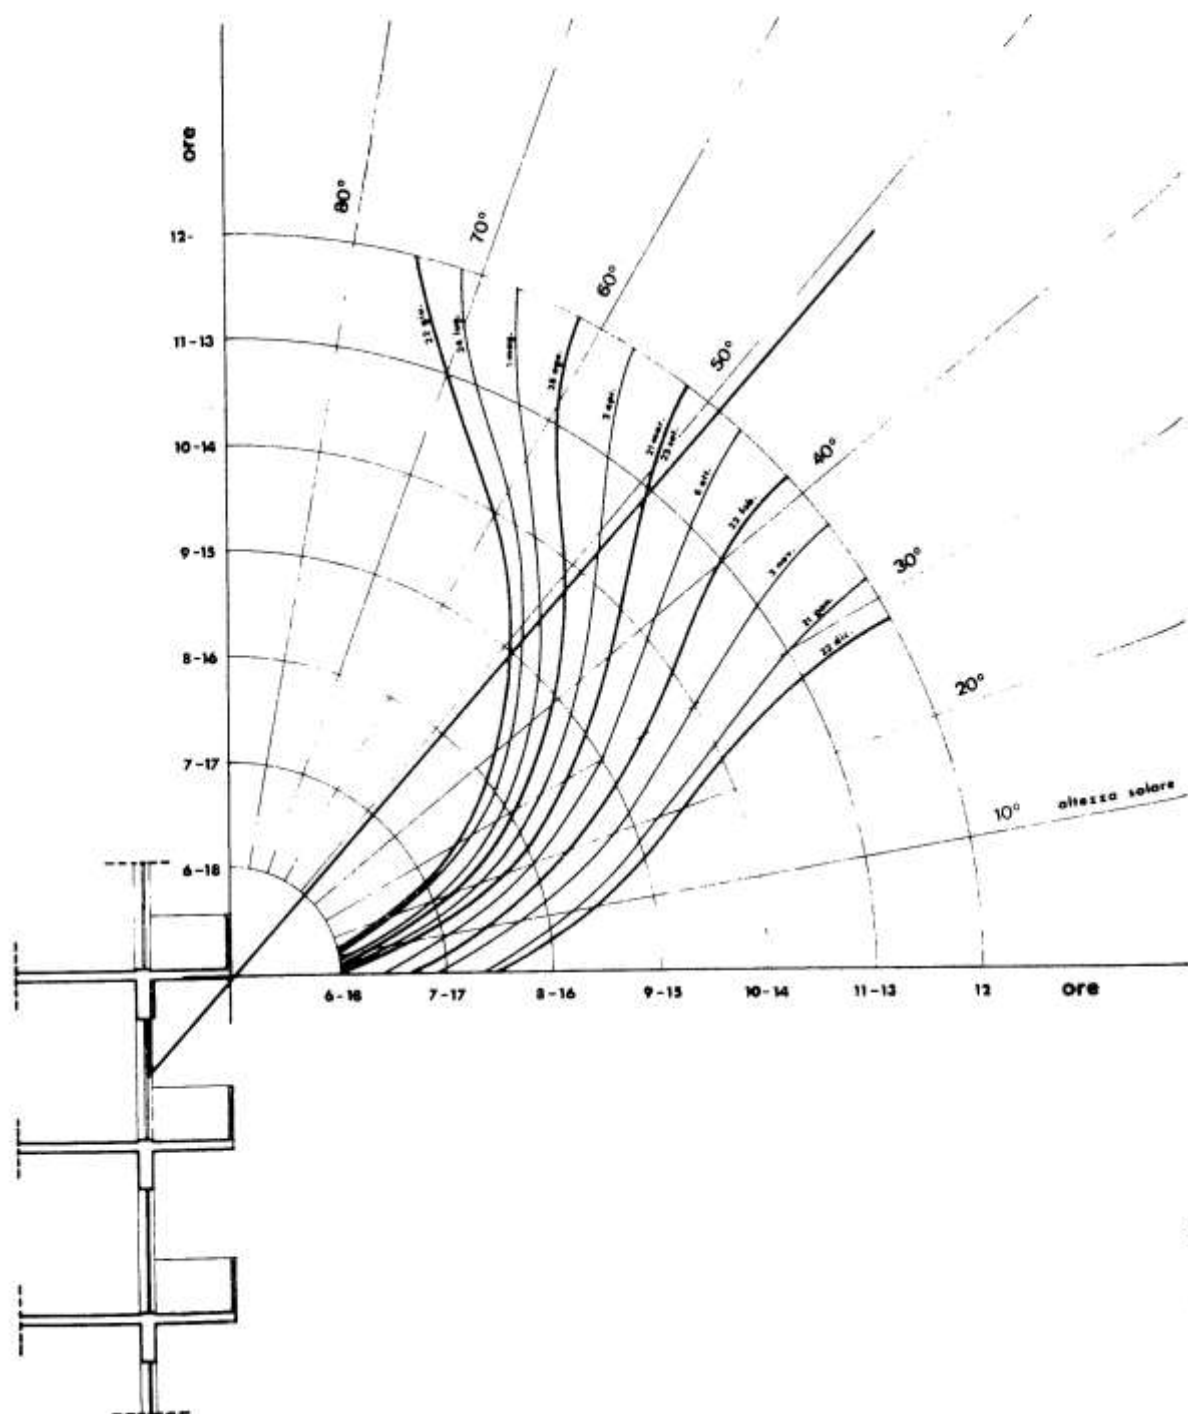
Determinazione della traccia dell'ombra proiettata dal balcone sul piano verticale.
